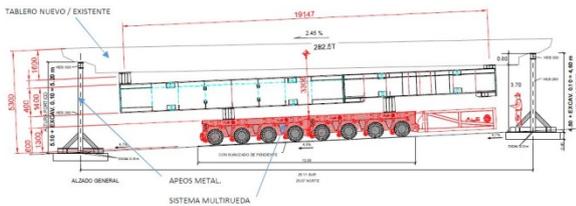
Vista del vano de hormigón retirado del lado sur sobre SPMT
